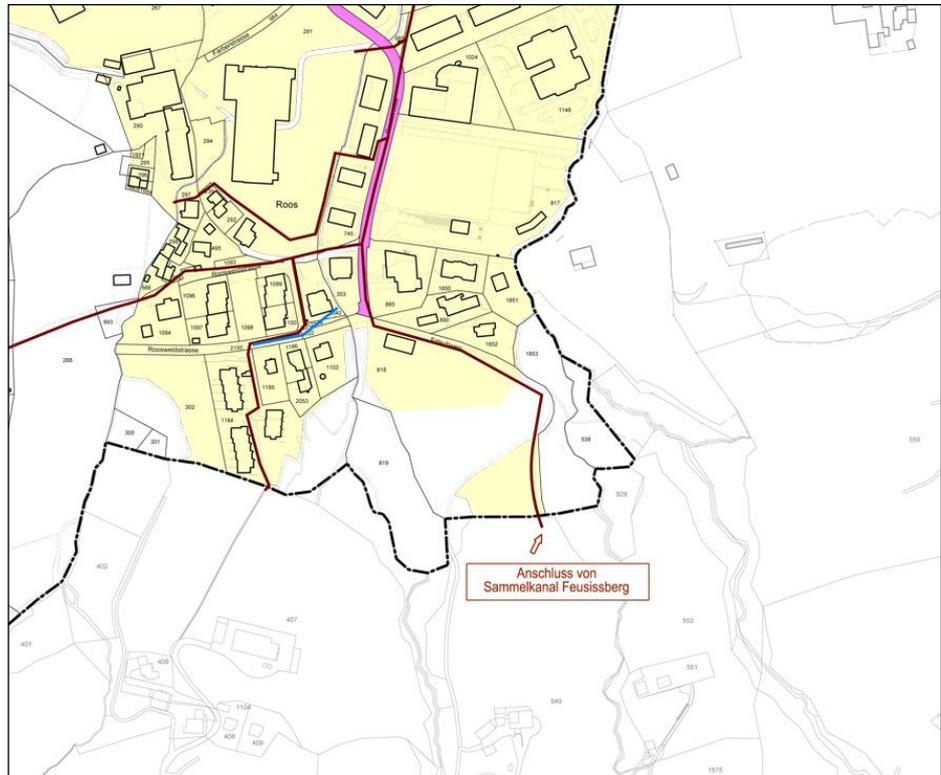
Ausschnitt Erschliessungsplan der Gemeinde Wollerau
